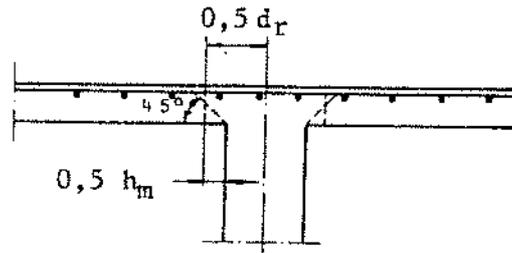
Losa sin refuerzo apoyada directamente sobre columnas.
